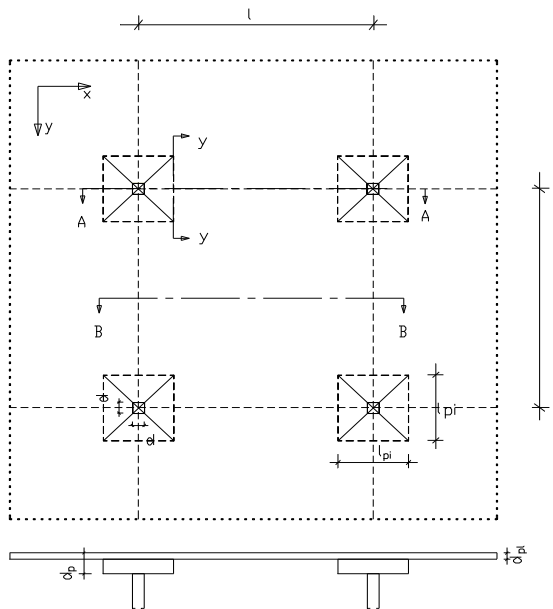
Ausschnitt aus einer regelmäßigen Flachdecke mit Pilzkopfverstärkungen
